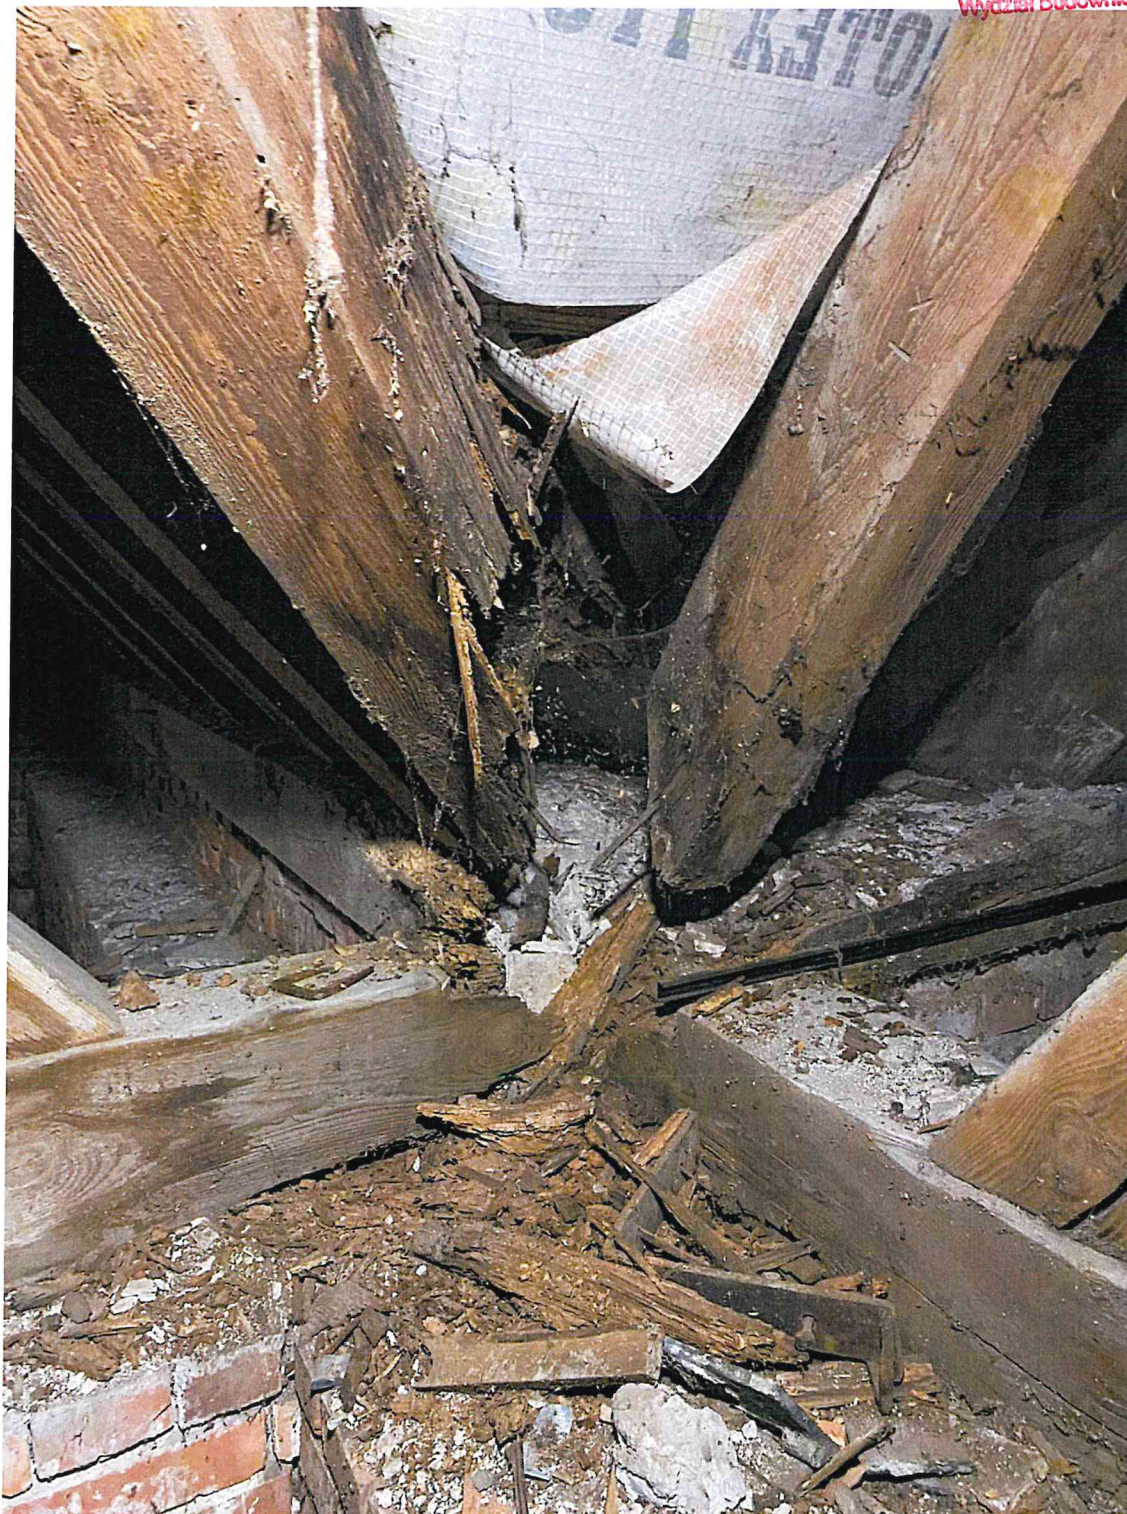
Kościół w Solcu – węzeł K-2, konstrukcja dachu, źródło: własne (sierpień 2023)
